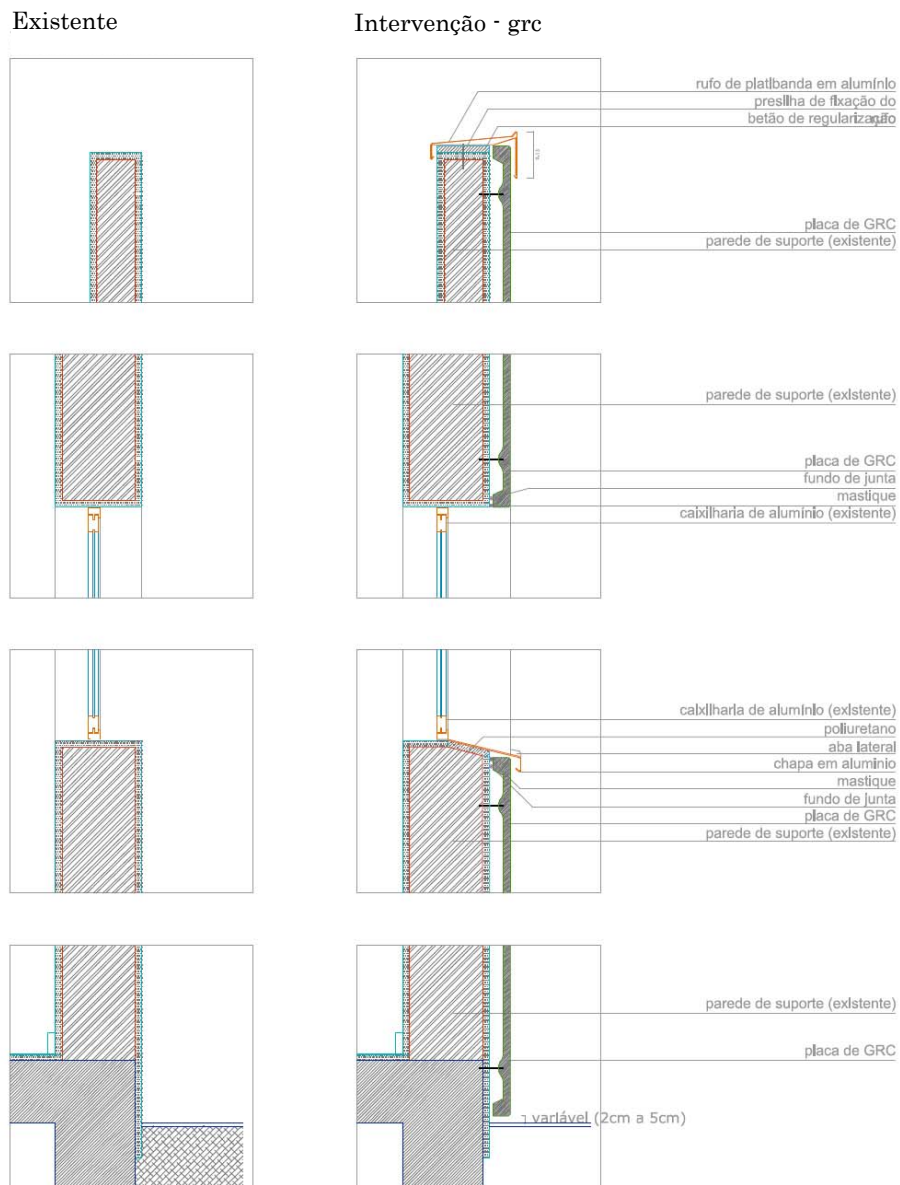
Corte construtivo vertical. Caixa de escadas (escala 1/20).
